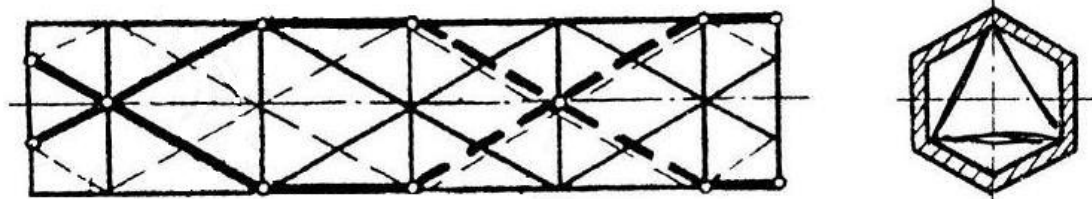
Релятивный цилиндрический винтовой барабан РЦ 3.5.a
